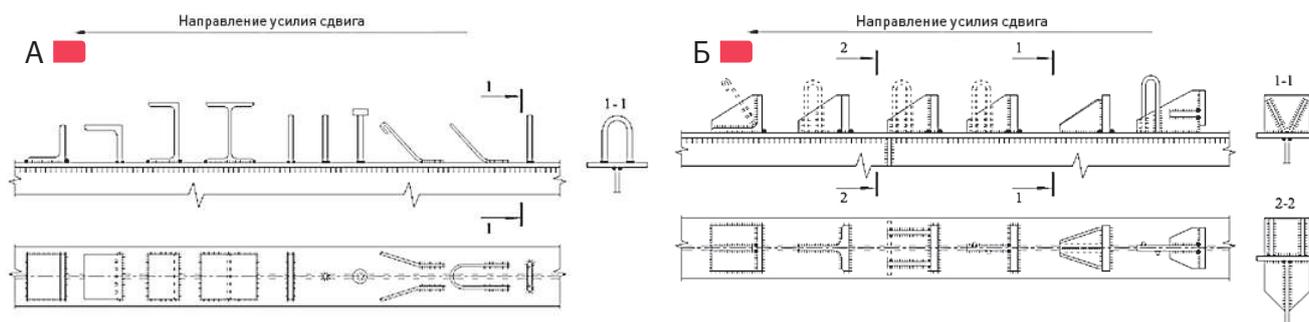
Типичные соединительные элементы, применяемые для объединения плит с существующими стальными балками для совместной сталежелезобетонной работы: А – гибкие; Б – жесткие
